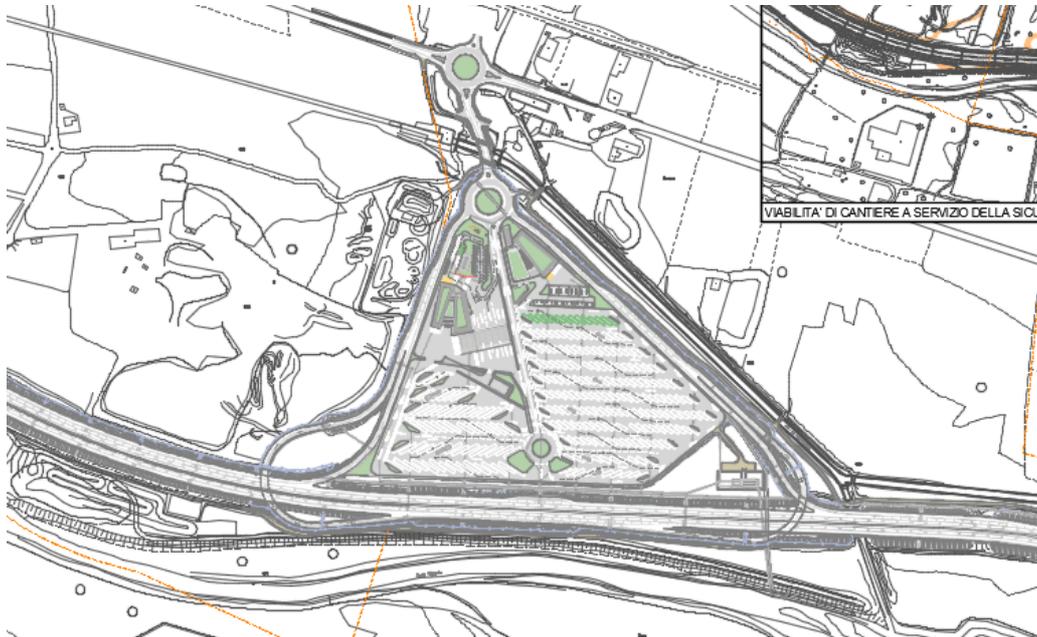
Estratto della planimetria di dettaglio delle opere stradali
